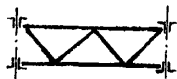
Схема решетки вертикальной связевой фермы высотой менее 3 м
